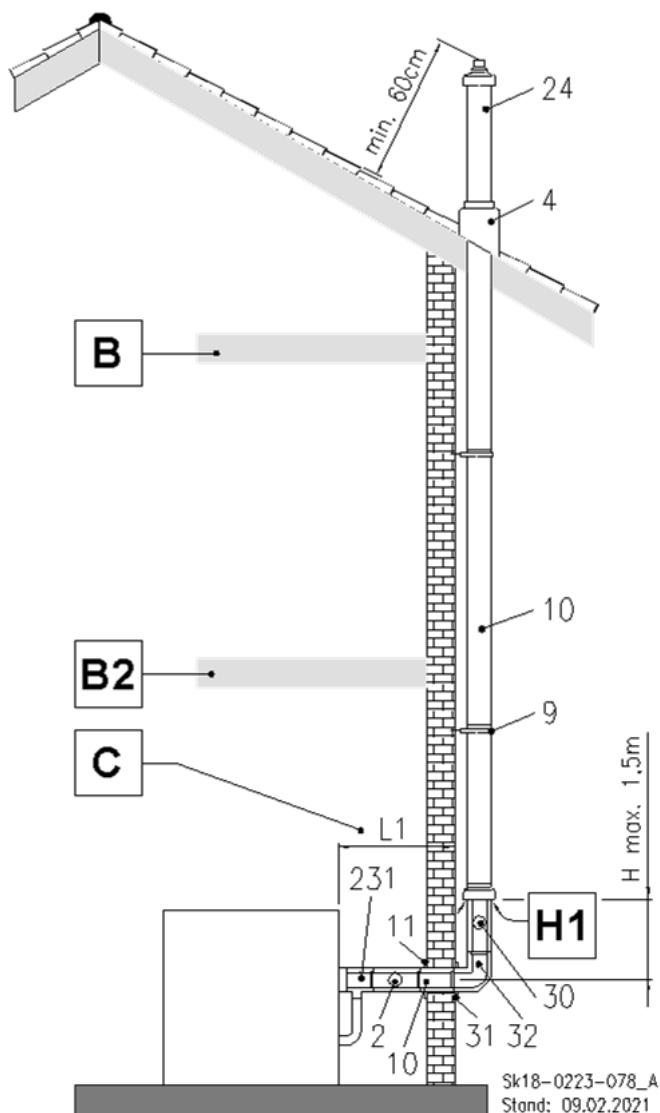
C_{53x} Raccordement à la paroi extérieure du système LAS
